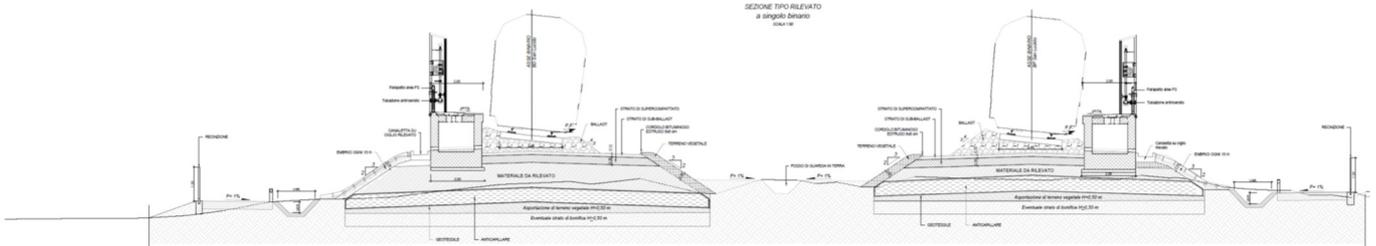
Sezione tipo in rilevato a singolo binario con marciapiede PES - rettilo
